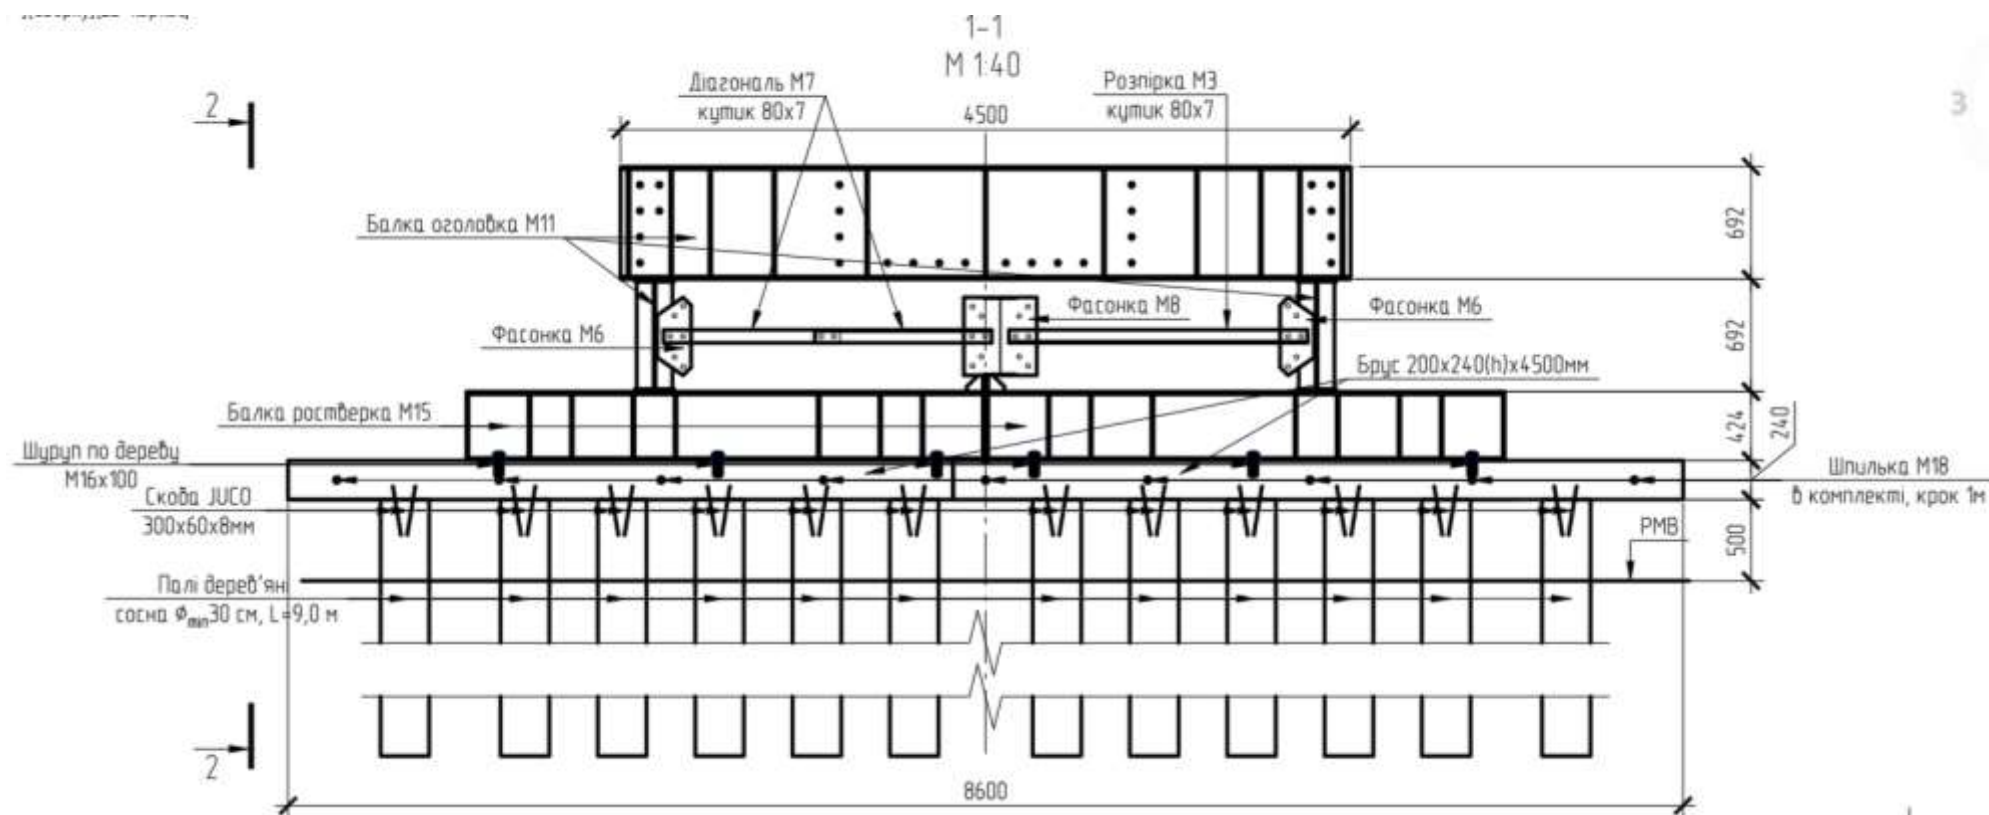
Влаштування надбудови опори з інвентарних конструкцій ИМИ-60. Переріз 1-1.
